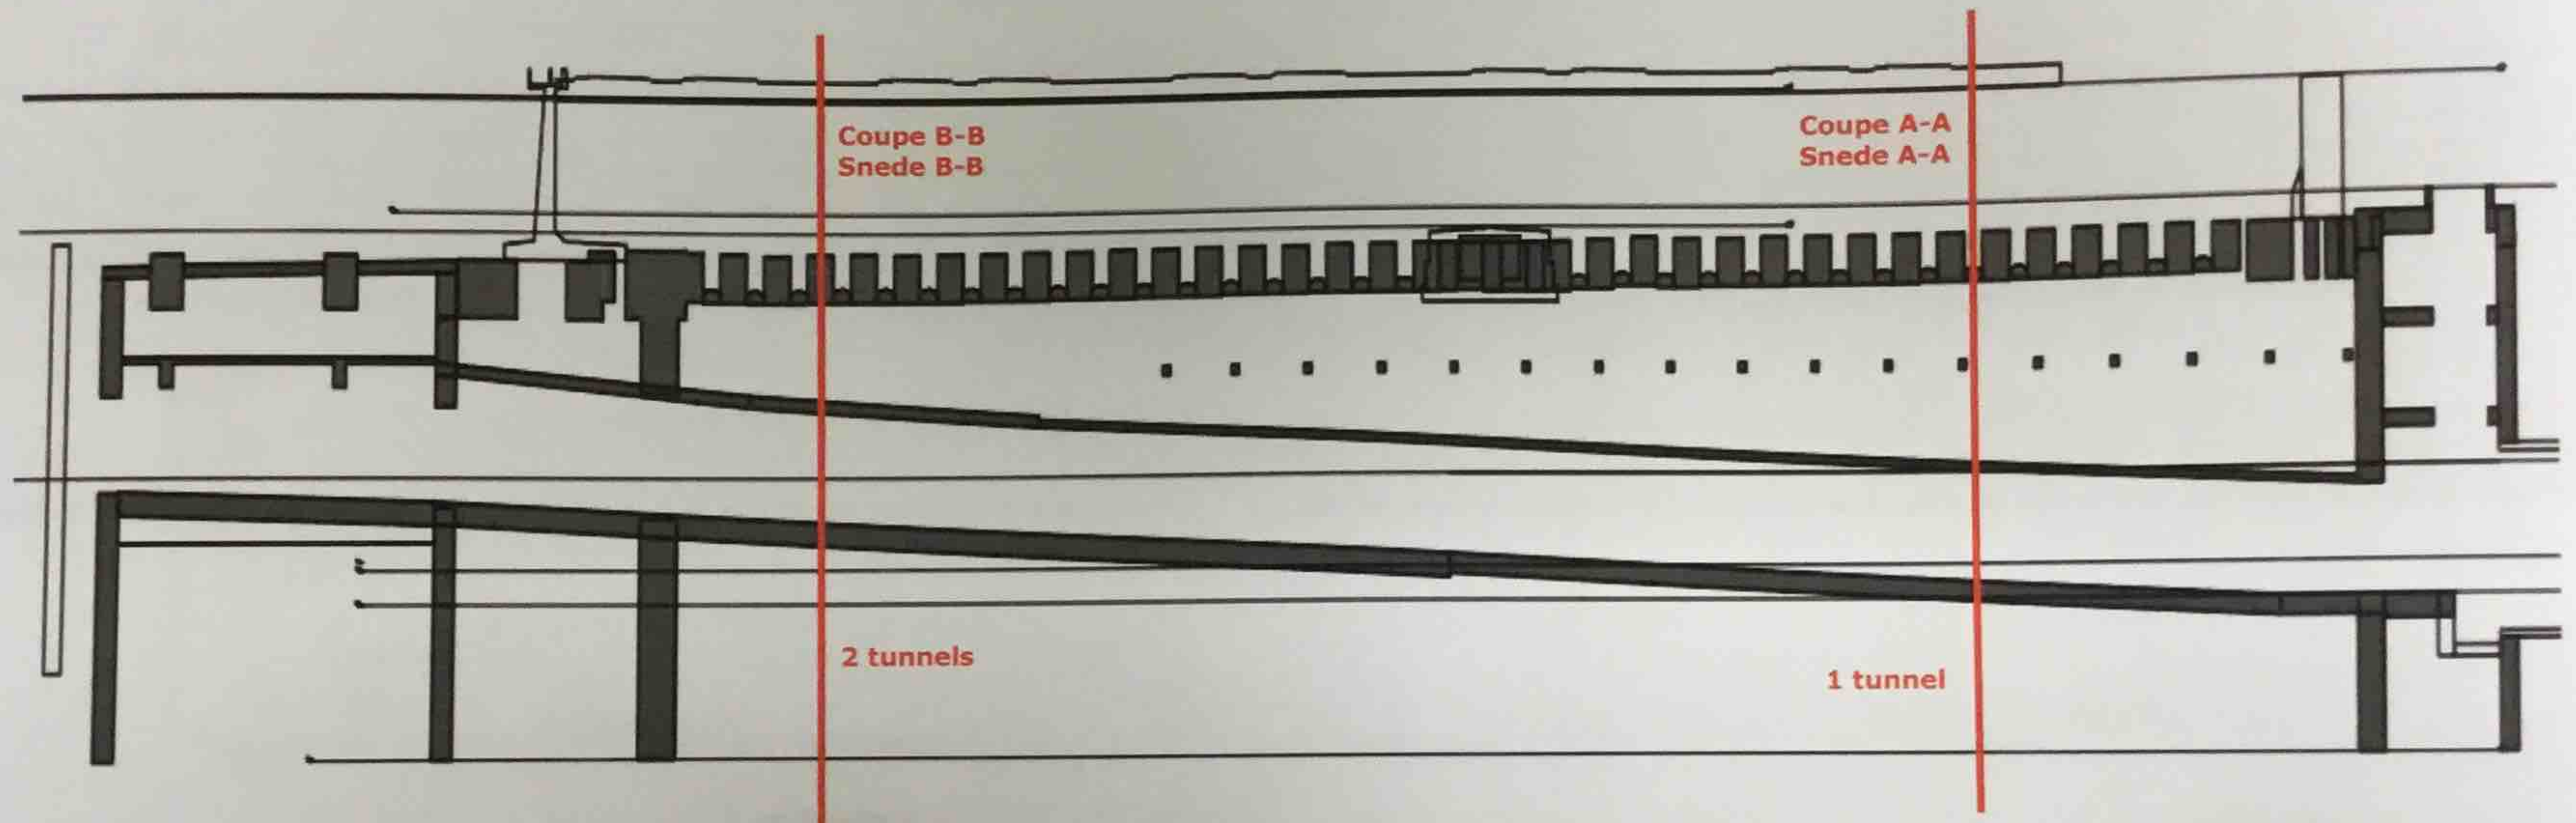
Coupe longitudinale C-C du tunnel / Langssnede C-C van de tunnel
